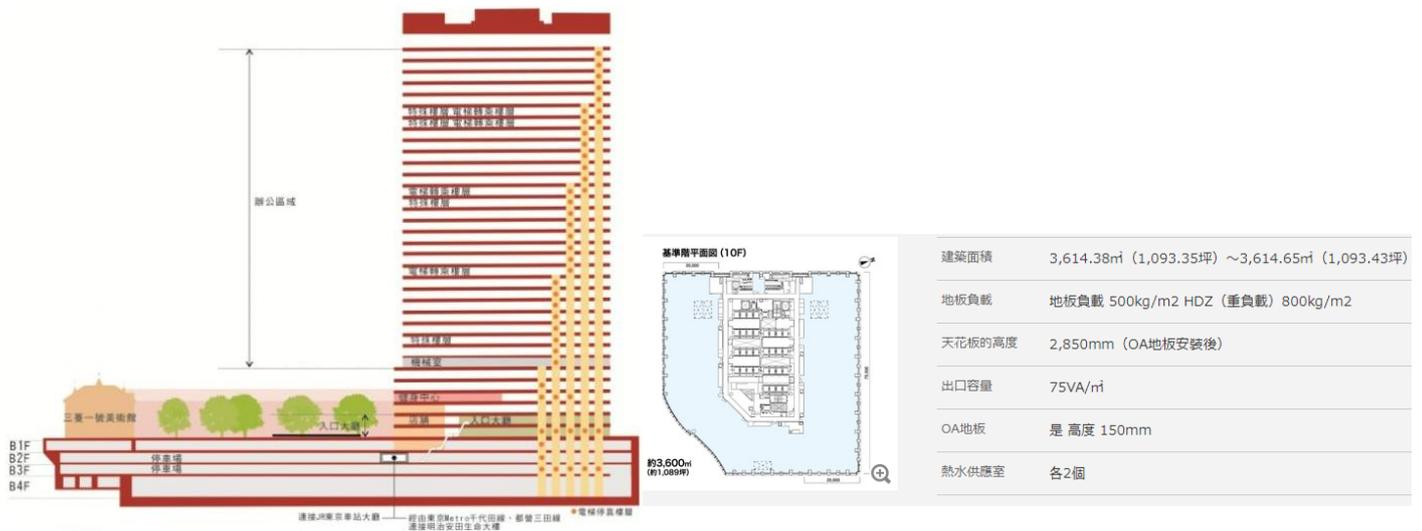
丸之內 Park Building 建物配置圖及標準層平面圖
